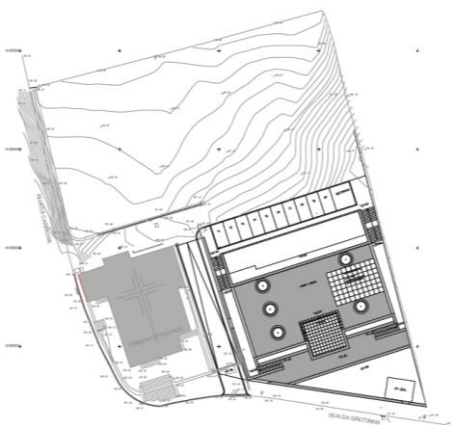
Planta de implantação da 1ª fase de intervenção
